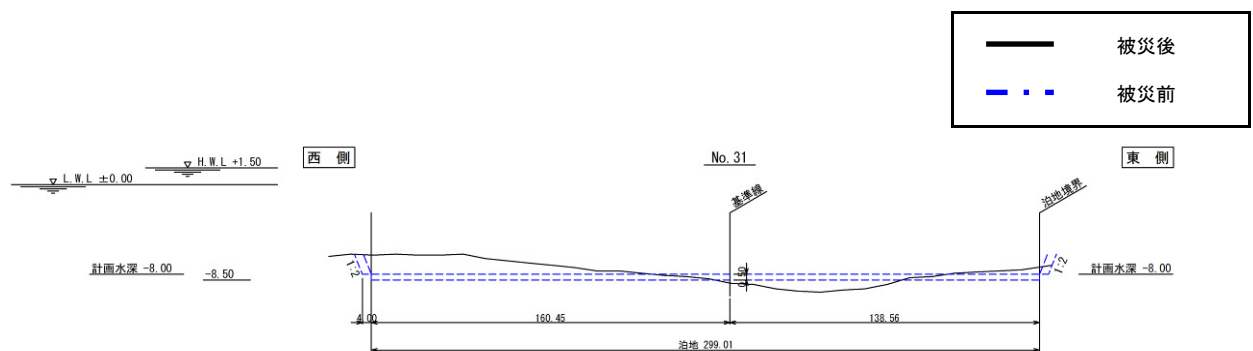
No.2 大洗港区\_中央地区泊地 (-8m) の断面図 (被災後)
